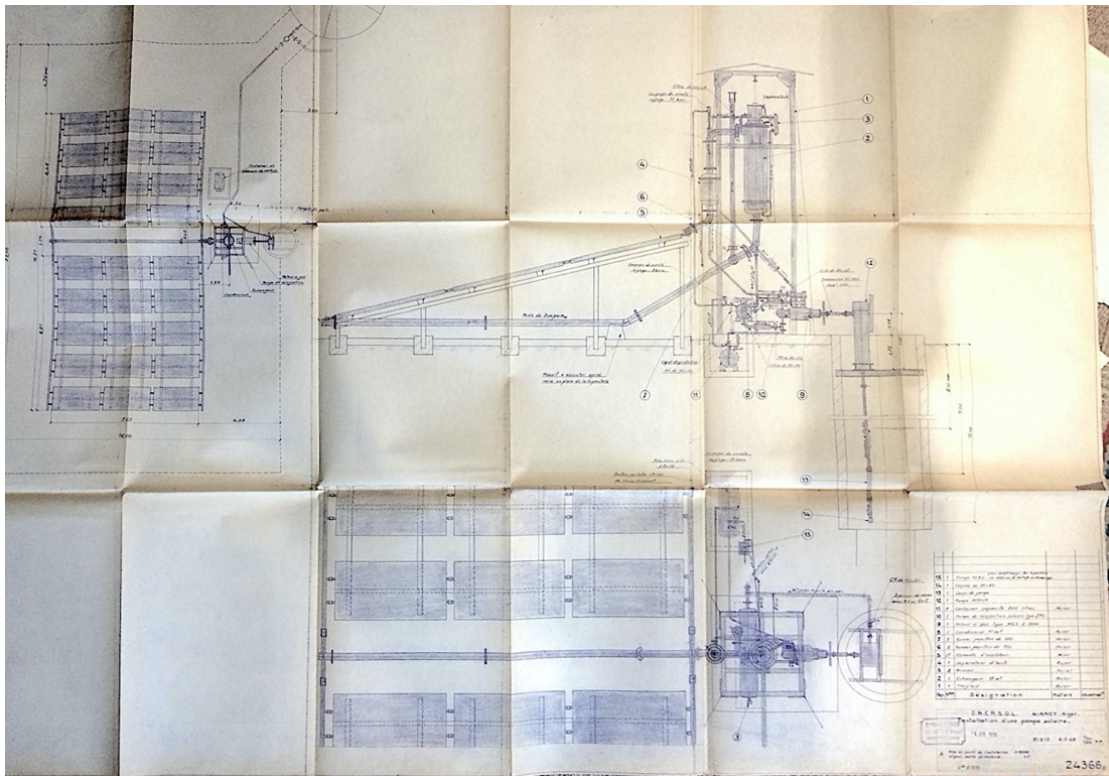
plan Mengin de la pompe ONERSOL. Plan N°24366, 8 juillet 1968, archives personnelles de Georges Alexandroff.
